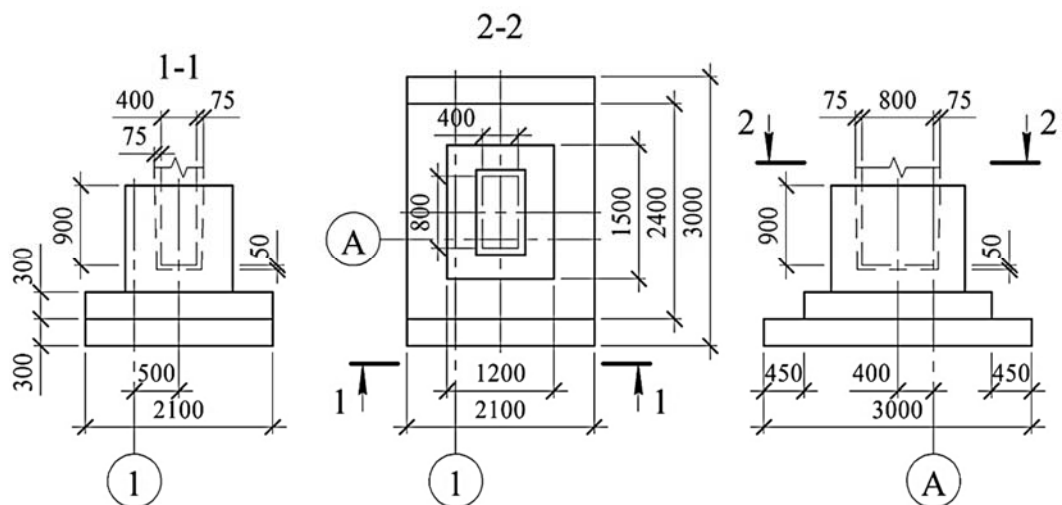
Конструктивная схема фундаментов, расположенных по крайней оси
